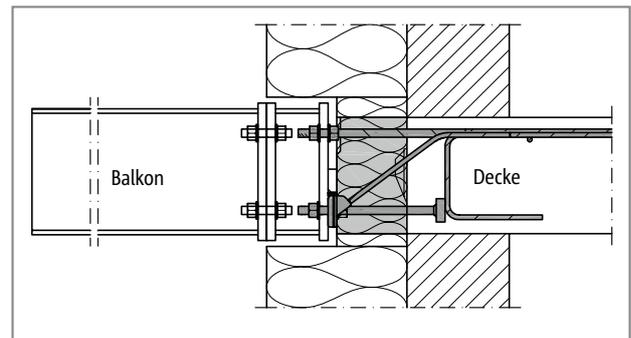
Schöck Isokorb® XT Typ SK: Anschluss des Stahlträgers an einen Adapter, der die Dicke der Außendämmung ausgleicht
